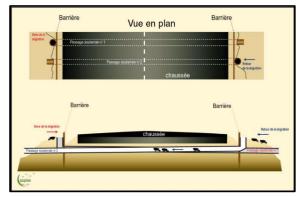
Installation permanente au bord d'une chaussée pour la circulation des animaux.
